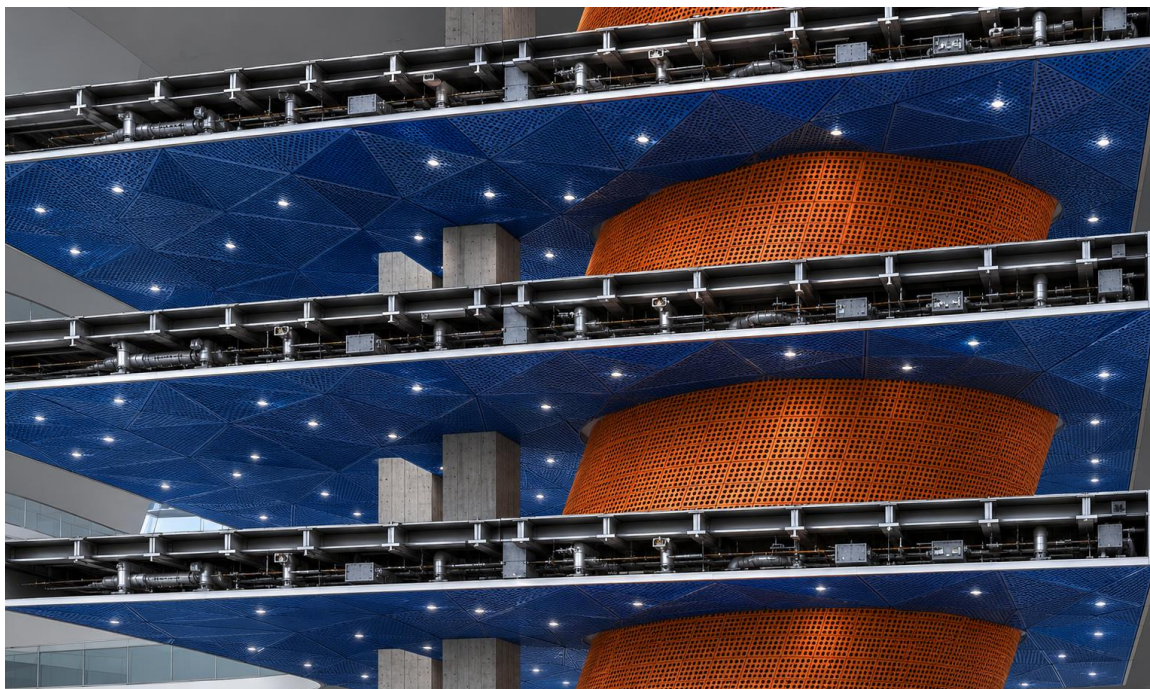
Render detalle del sistema estructural y revestimiento interior-Elaboración propia
